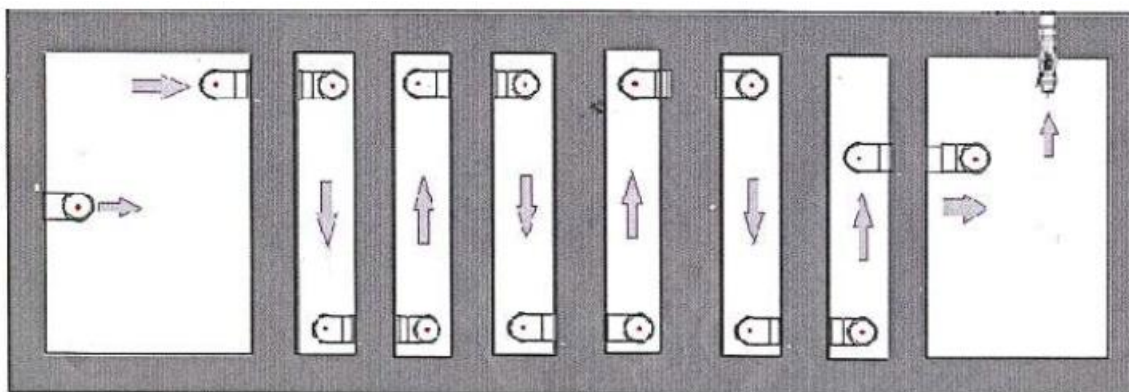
Planta baixa da Caixa separadora de água, óleo e lama.
